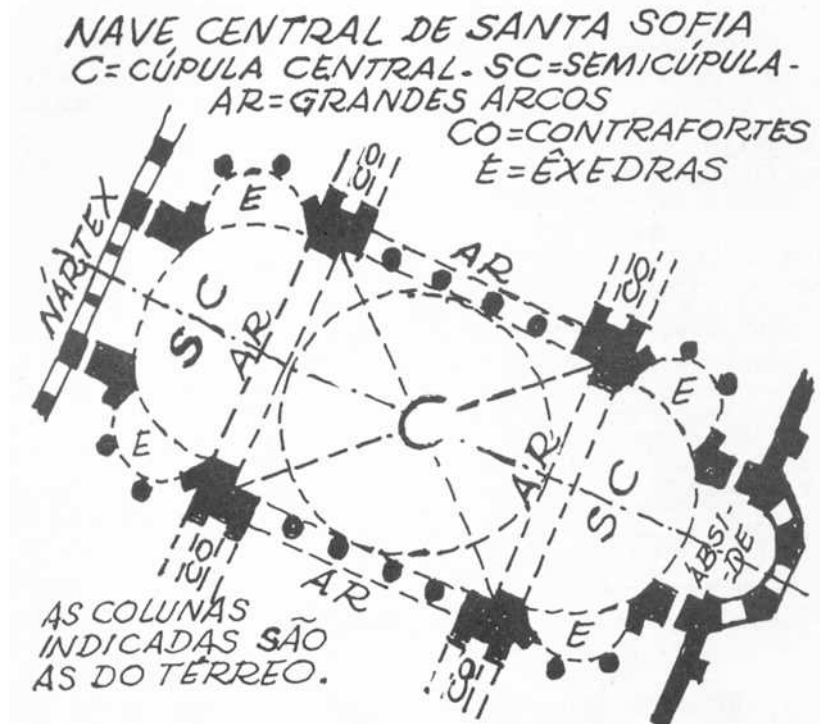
Planta esquemática da nave central da Igreja de Santa Sofia
